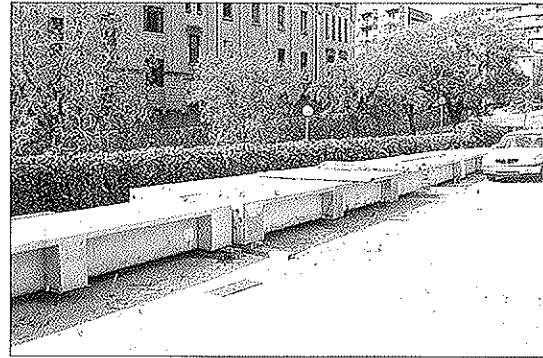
Tramos de las vigas continuas acopiadas a la entrada del laboratorio.
